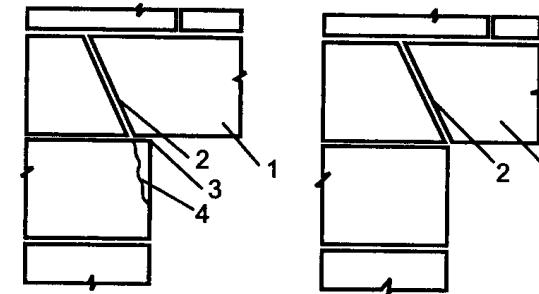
Неправильное (а) и правильное (б) опирание перемычечного блока на кладку:
